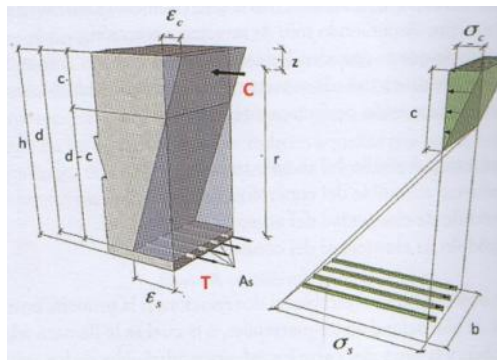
Estado de deformaciones y esfuerzos en una sección de concreto reforzado solicitada a flexión fuente (Lamus & Andrade, 2015)
